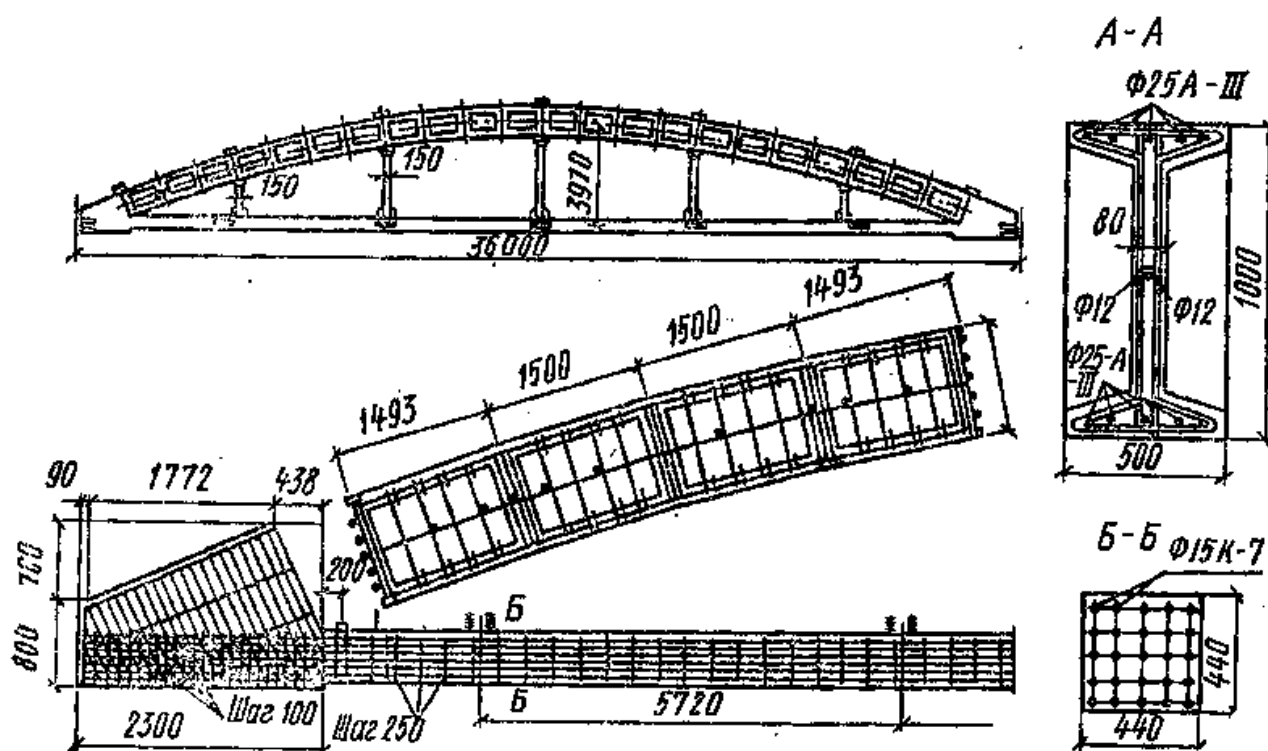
Железобетонная арка двутаврового сечения с затяжкой
